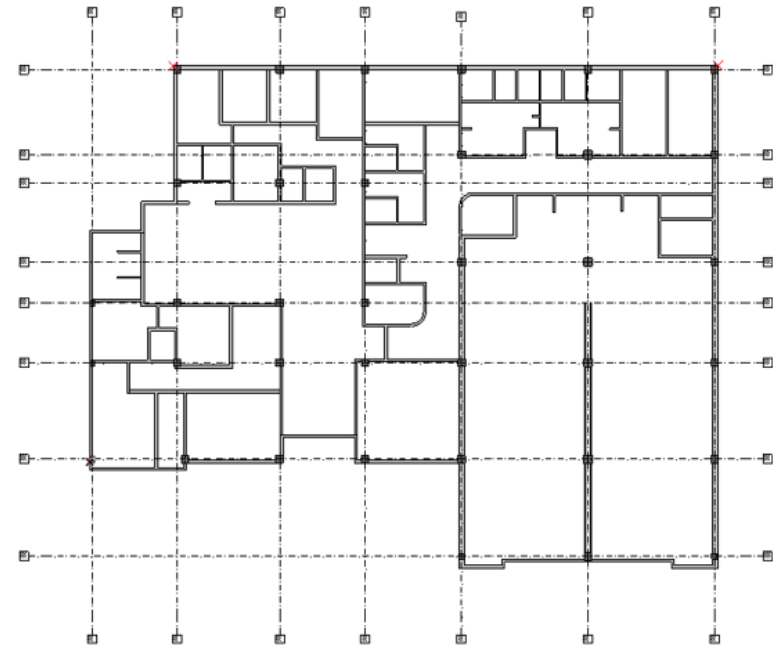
Vista planta baja paredes interiores. Elaboración: Del autor.
